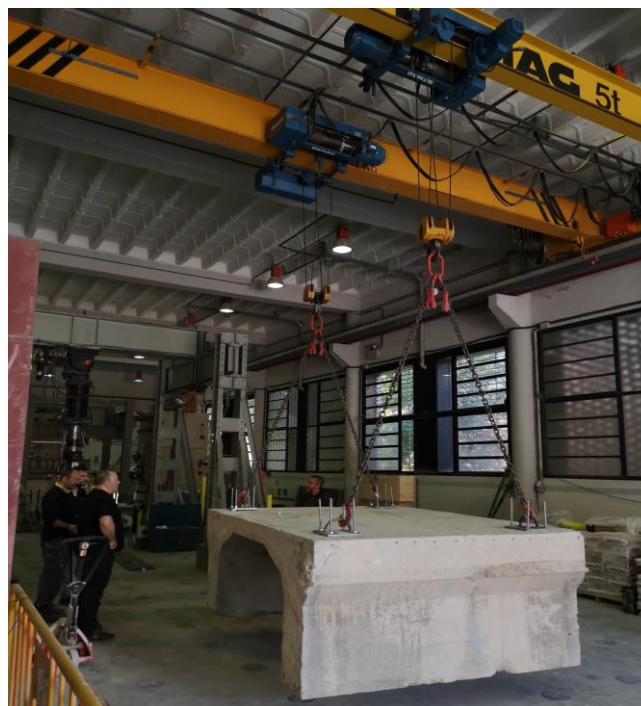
Puente grúa laboratorio de estructuras capacidad 5 toneladas.
